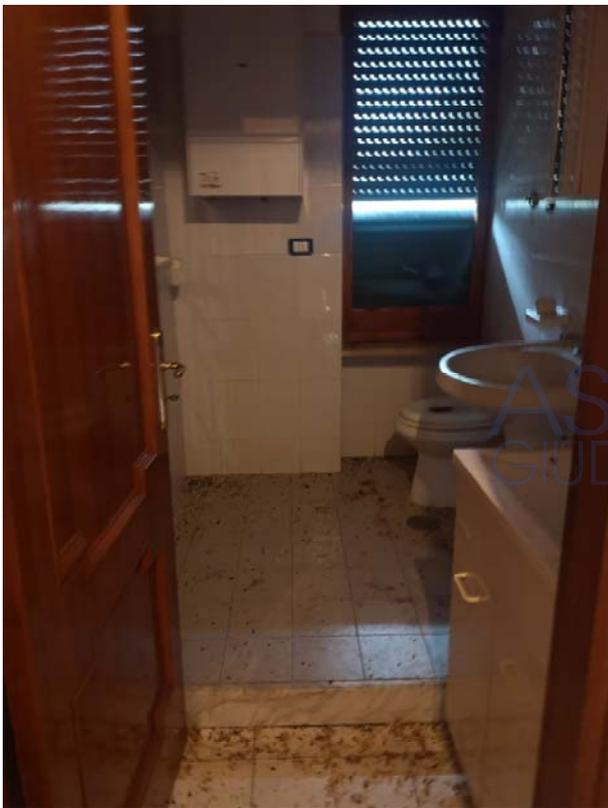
SERVIZIO IGIENICO AL PIANO TERRA CON FINESTRA E AFFACCIO SUL PROSPETTO OVEST
